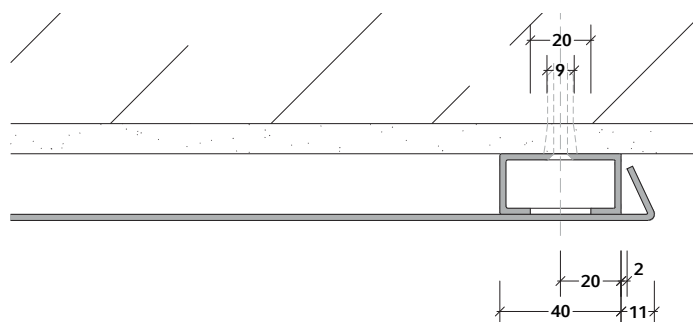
Gebäudekennzeichnung ohne Standrohr | Detail 02
